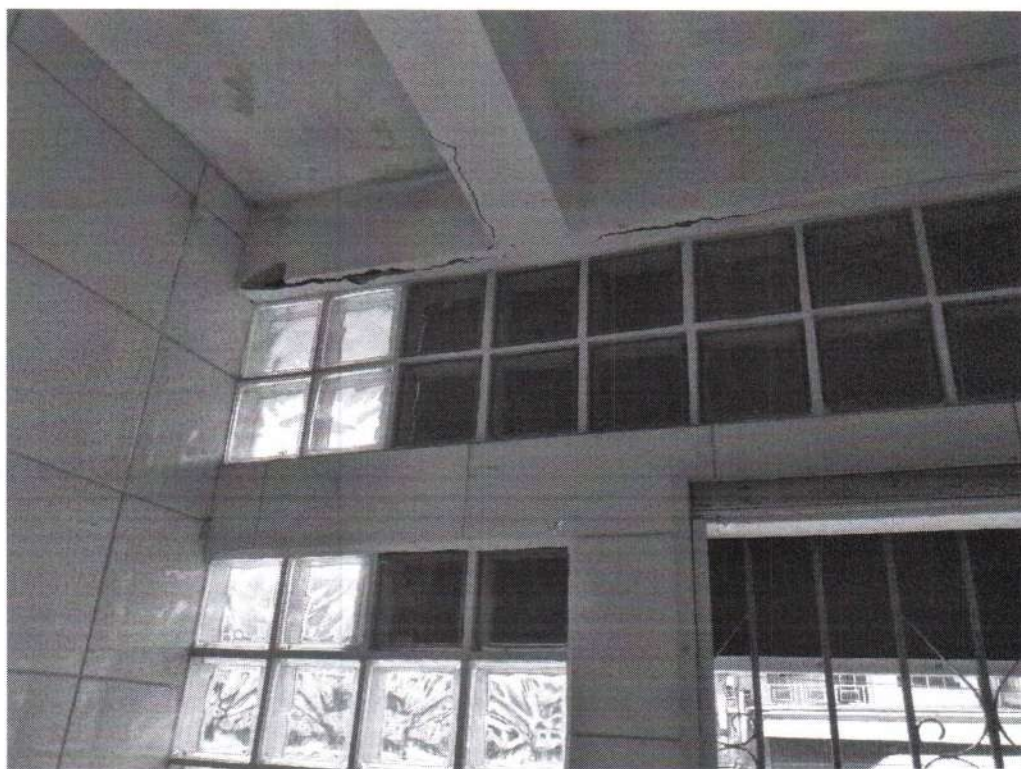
VIGA COMPROMETIDA COM FISSURAS NO HALL DE ENTRADA
